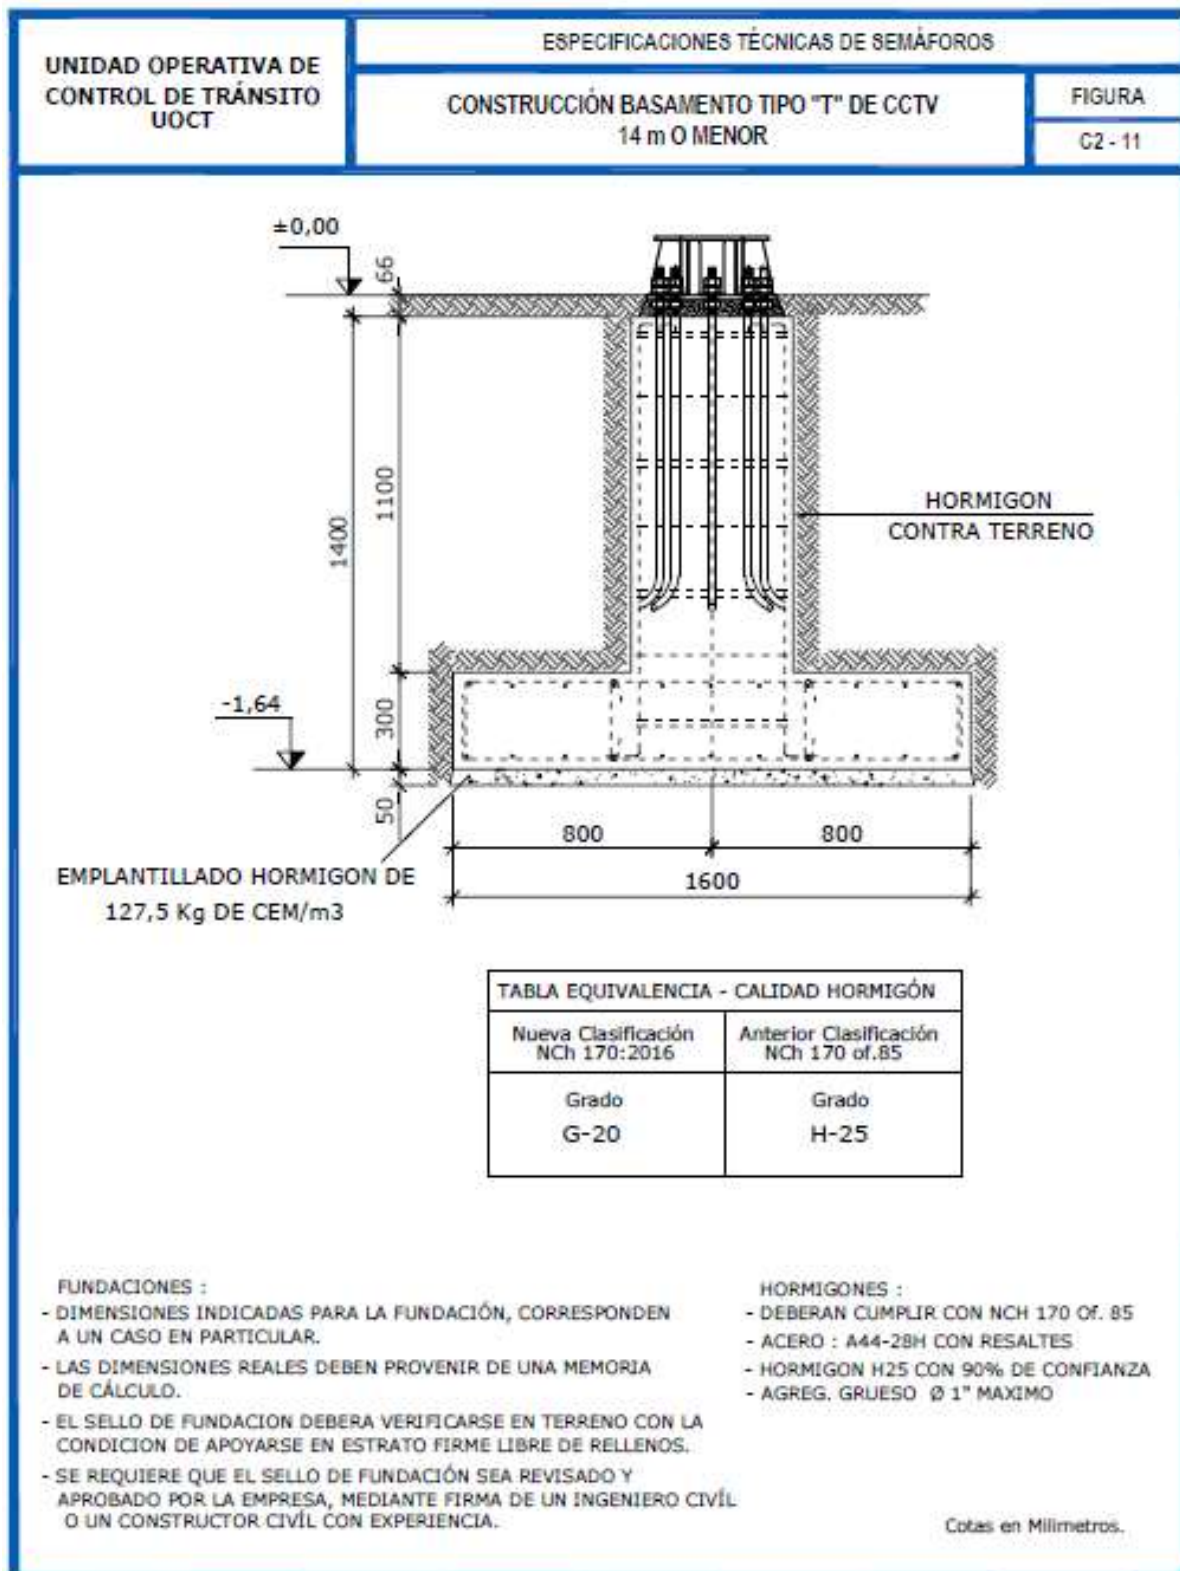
11 Construcción de Basamento Tipo "T" de Poste CCTV de 14 m o Menor
